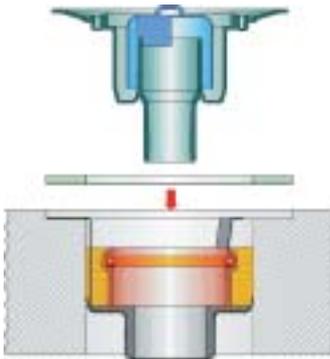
Dallmer Bodenablauf mit Rohbauset für den Brandschutz.
